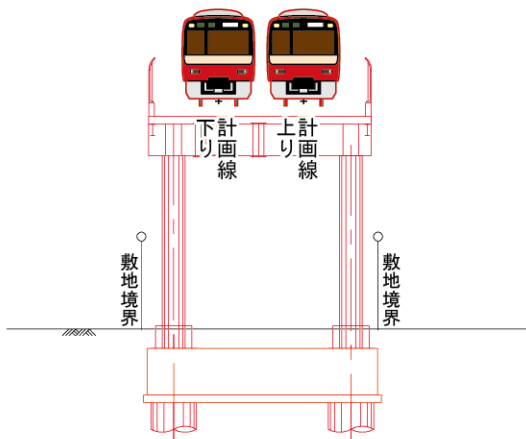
(4) 施工順序図 (一般部 高架橋区間)
